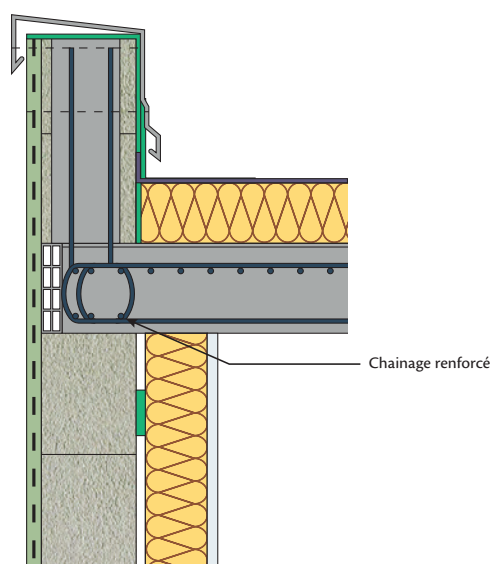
Exemple d'acrotère bas en blocs à bancher (Règles professionnelles de juillet 2018)
